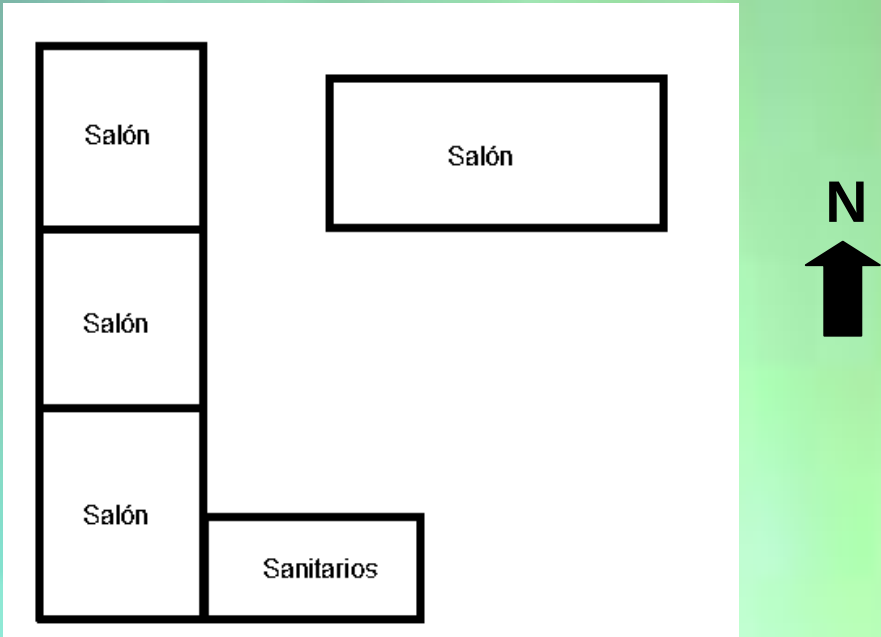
, Croquis de la planta de la Facultad de Ingeniería Eléctrica del Tecnológico de Morelia, Foto EDGM
